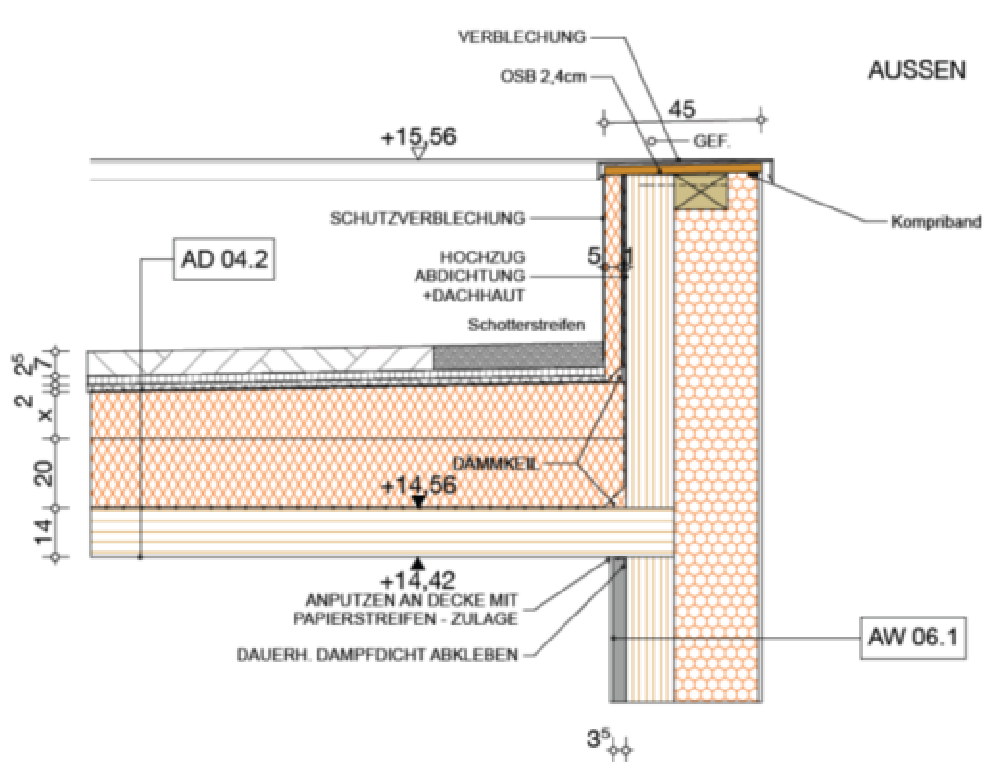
Fassadendetails vertikal. Quelle: Nussmüller Architekten ZT GmbH
